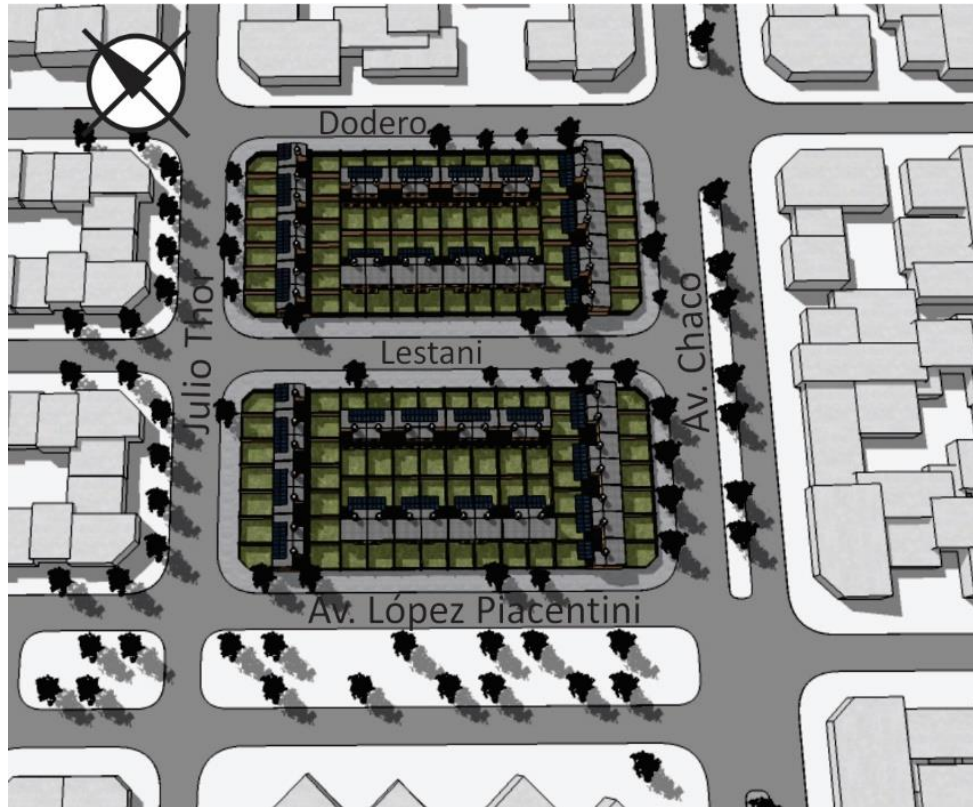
Planimetría de la propuesta de intervención con SFCR del B° MUPUNNE.
